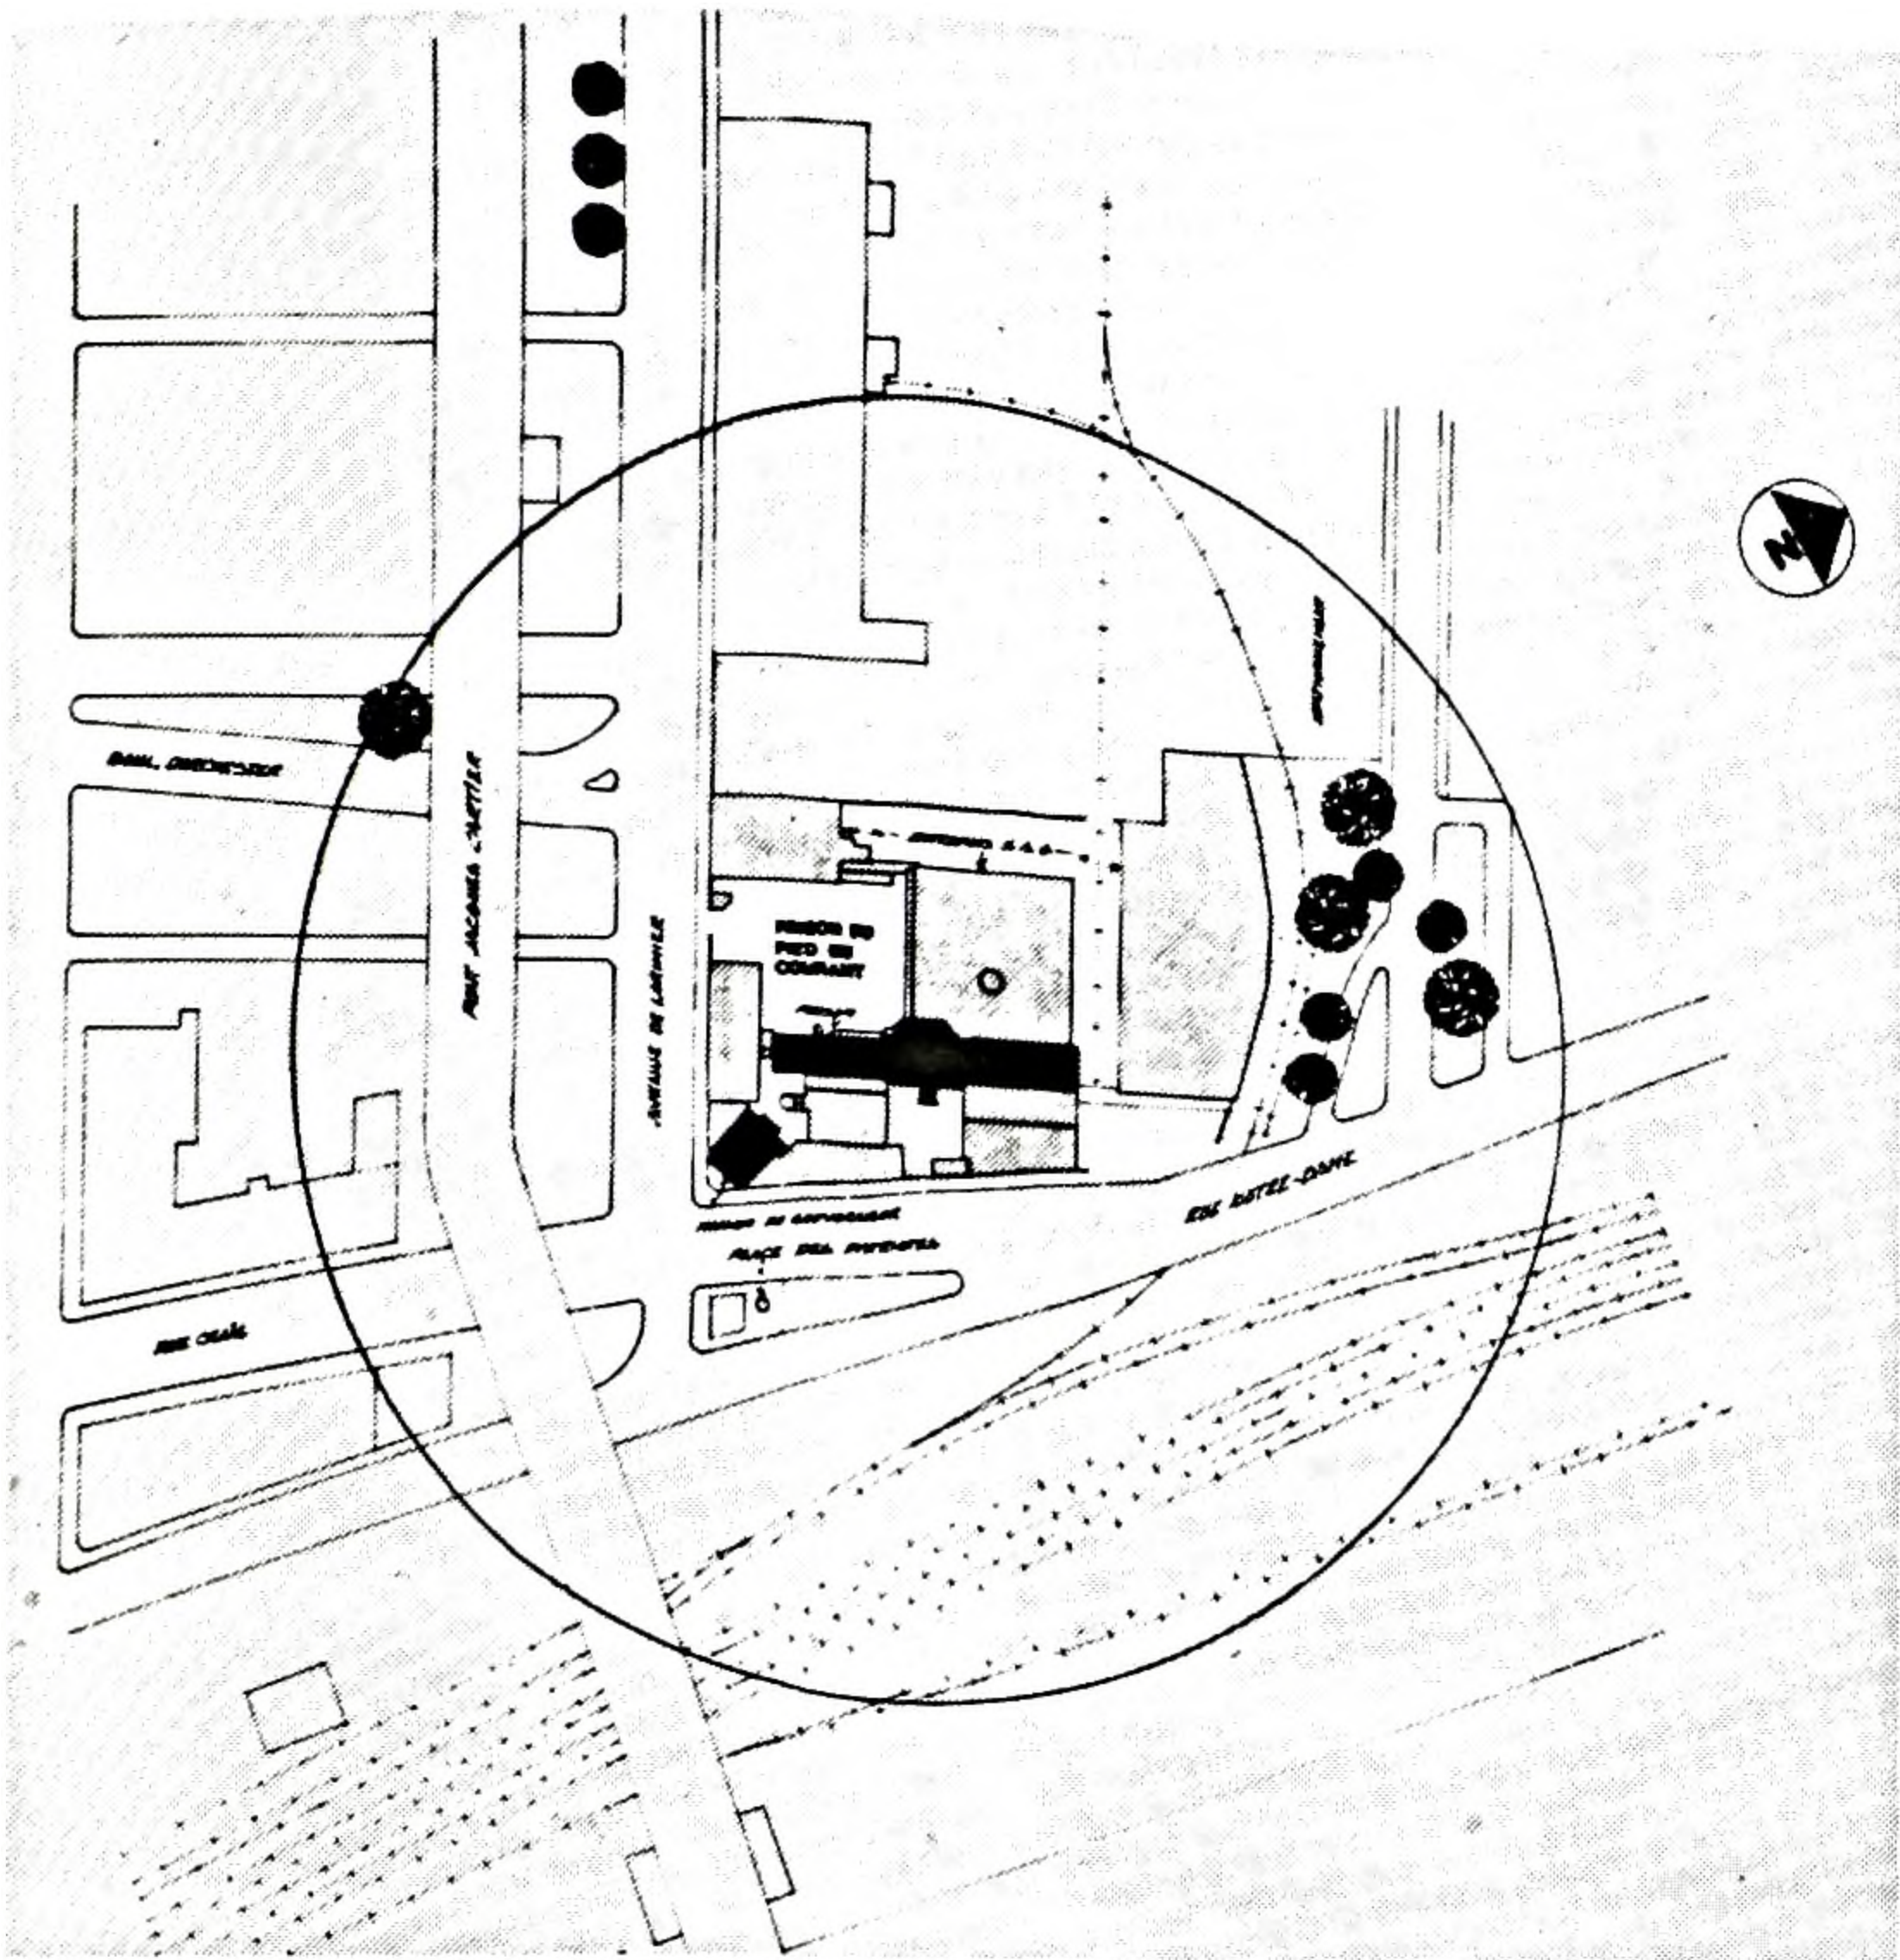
Plan du site de la prison du Pied-du-Courant. (Dessin de Pierre d'Anjou et Georges Leonidoff).
